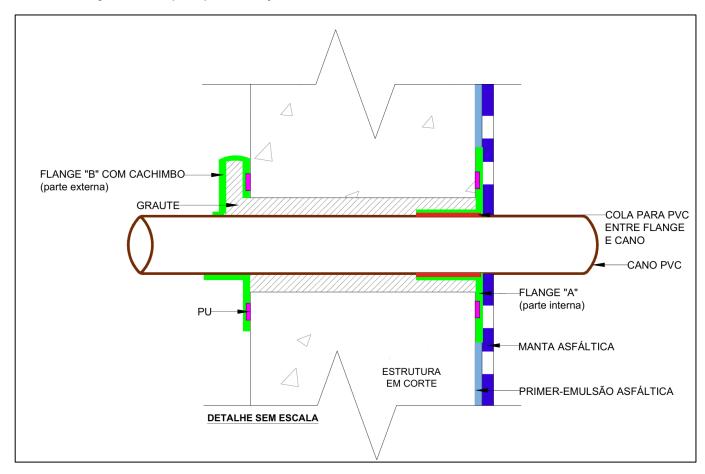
Detalhe do flange impermeabilizado com manta asfáltica – sem escala.
